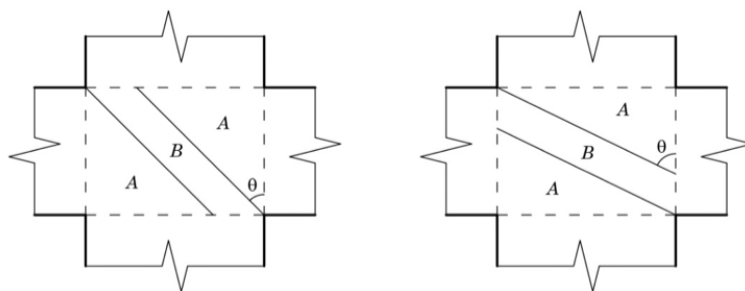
puntone pilastro-pilastro (sinistra), puntone trave-trave (destra)
